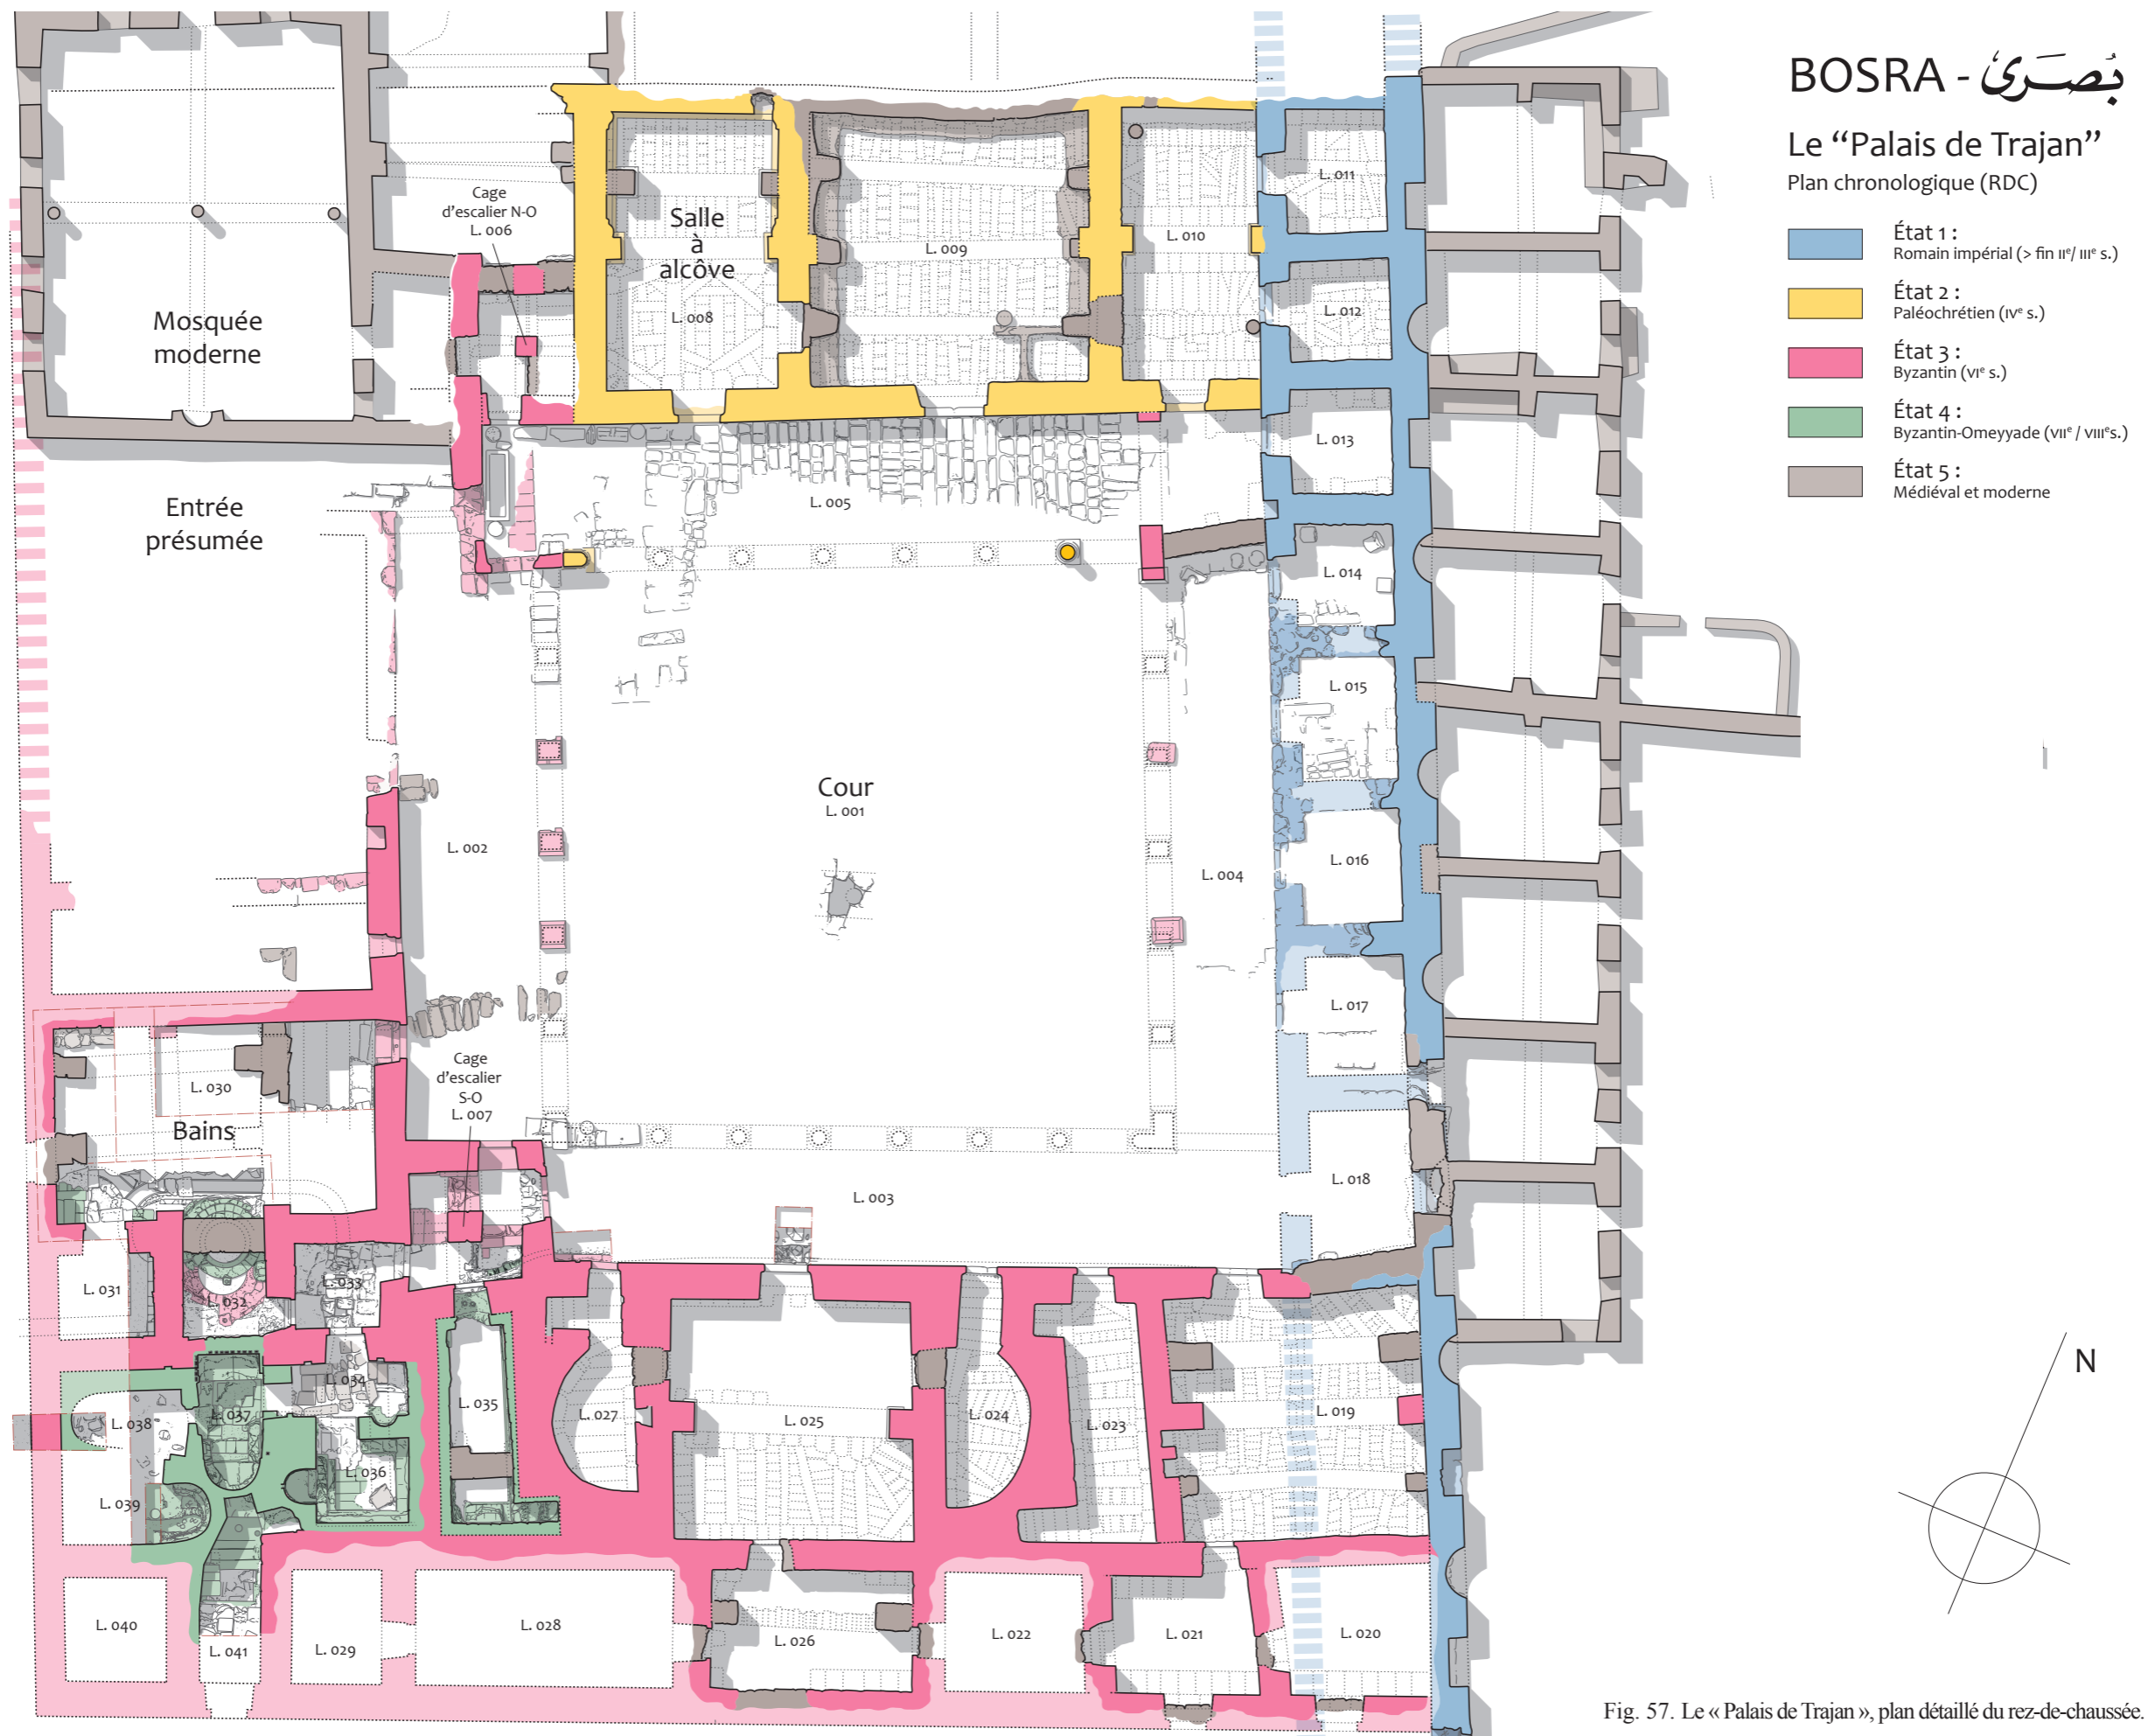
Le « Palais de Trajan », plan détaillé du rez-de-chaussée. Chronologie
